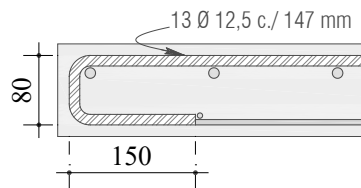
Detalhe da ancoragem da armadura principal (mm)
